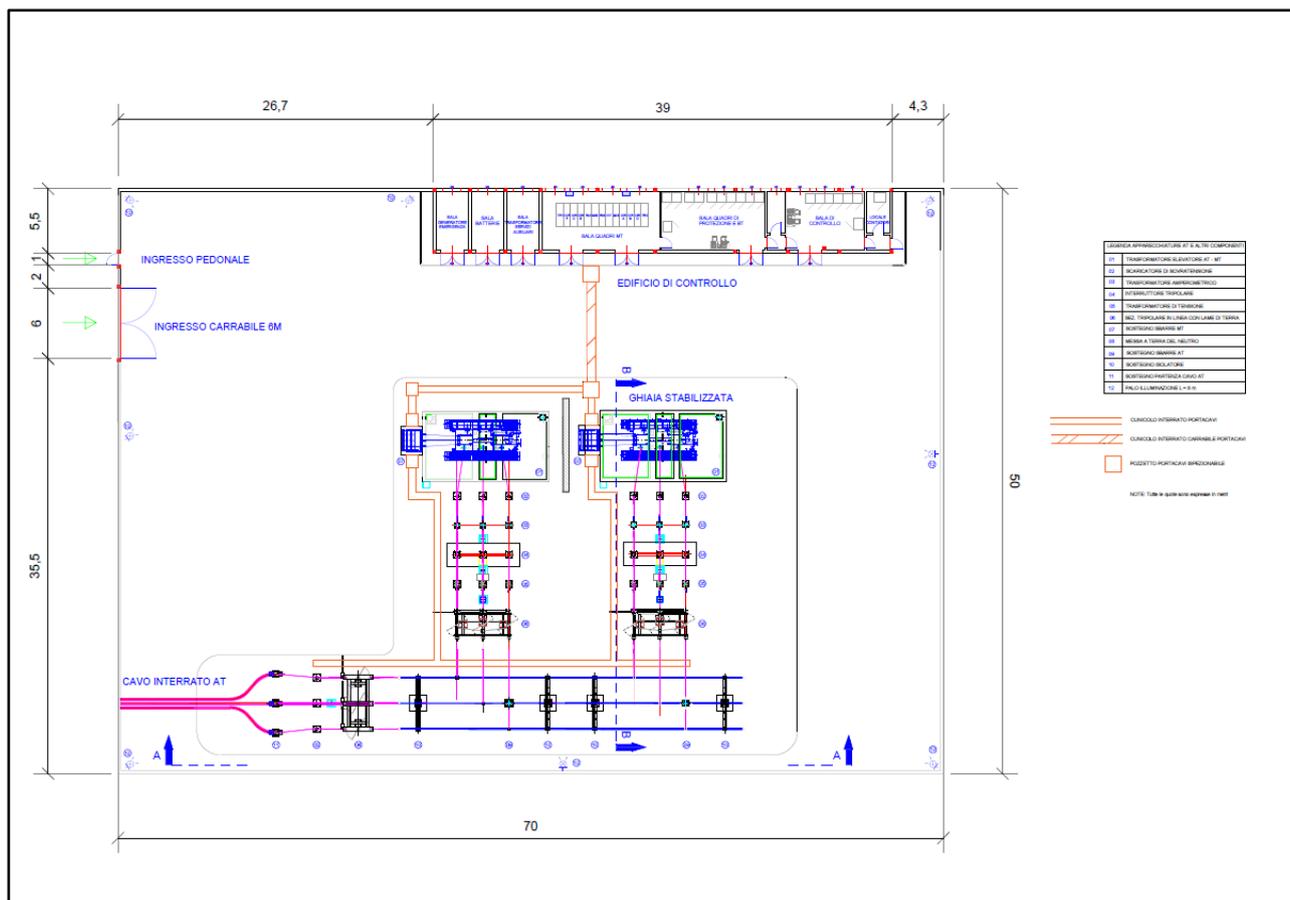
Planimetria elettromeccanica della Stazione Utente
